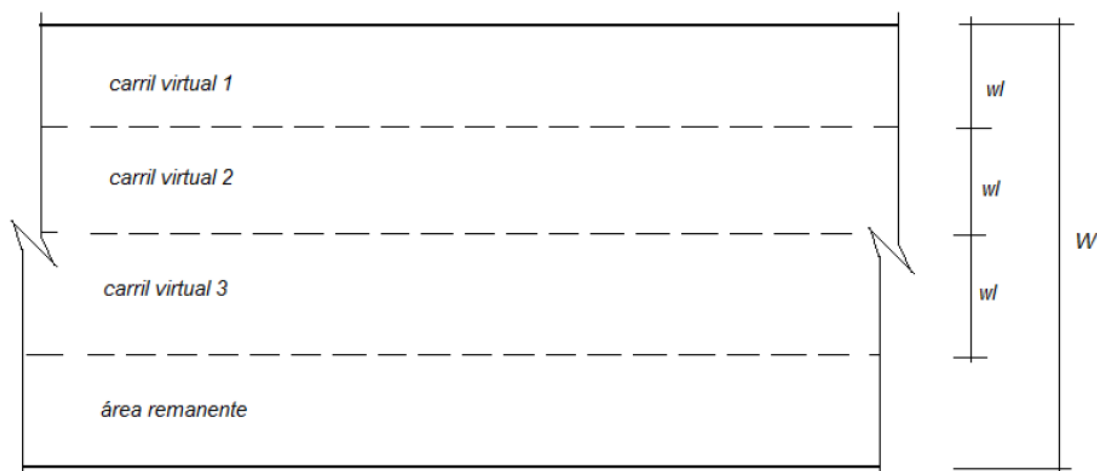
Ejemplo genérico de distribución de carriles virtuales. (Fuente: Planos anteproyecto)
